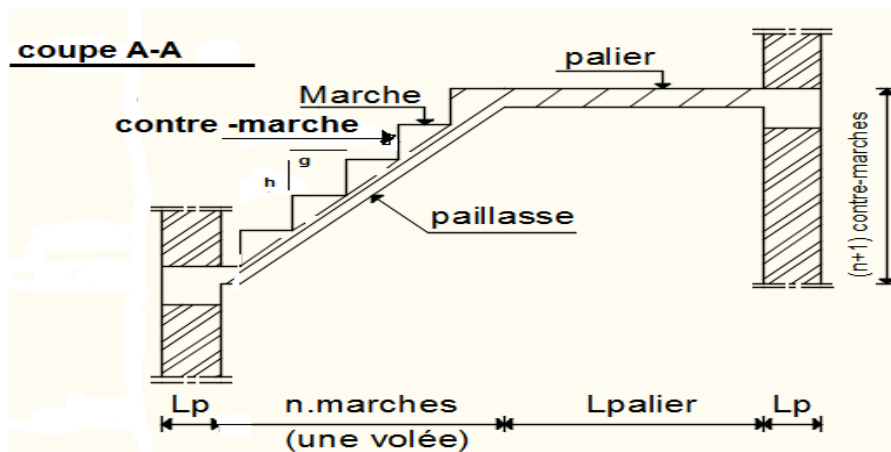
Coupe sur la cage d'escaliers.
